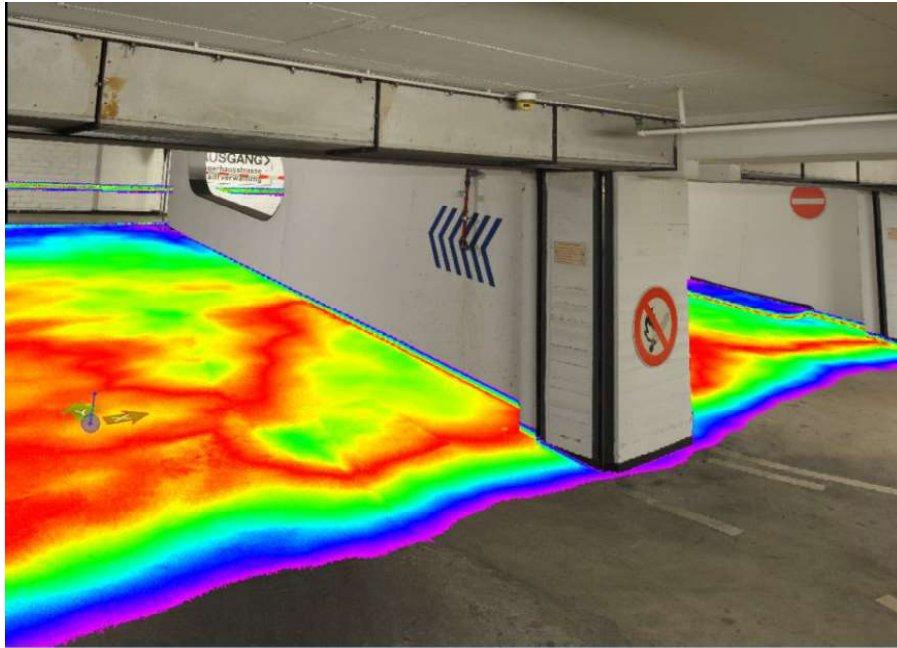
3D-Scan, Visualisierung der Betonunebenheit einer Rampe.
